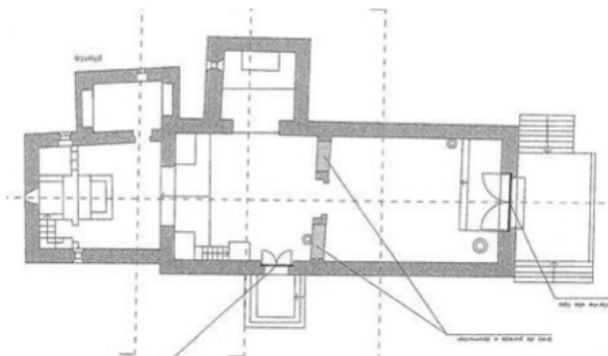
Planta de S.ta Maria do Castelo de Castelo Mendo. IHRU.
